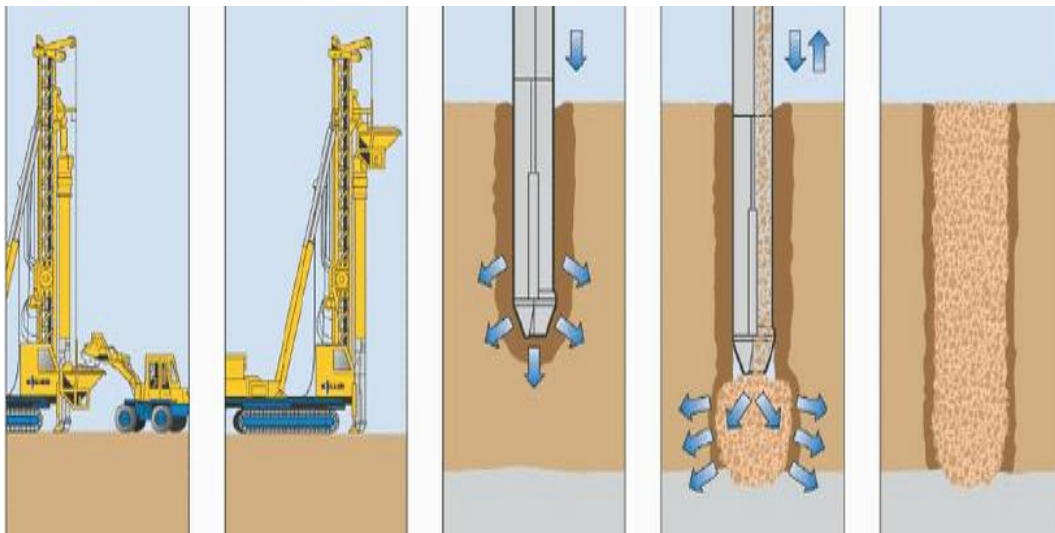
Processus d'installation de la colonne de pierre.
